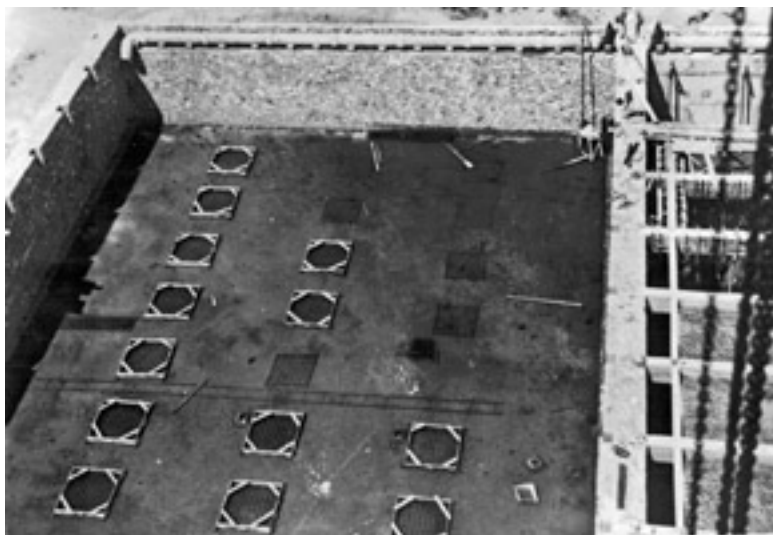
Zapatas interiores del depósito de almacenaje. AMAB, fotografía s/núm.
